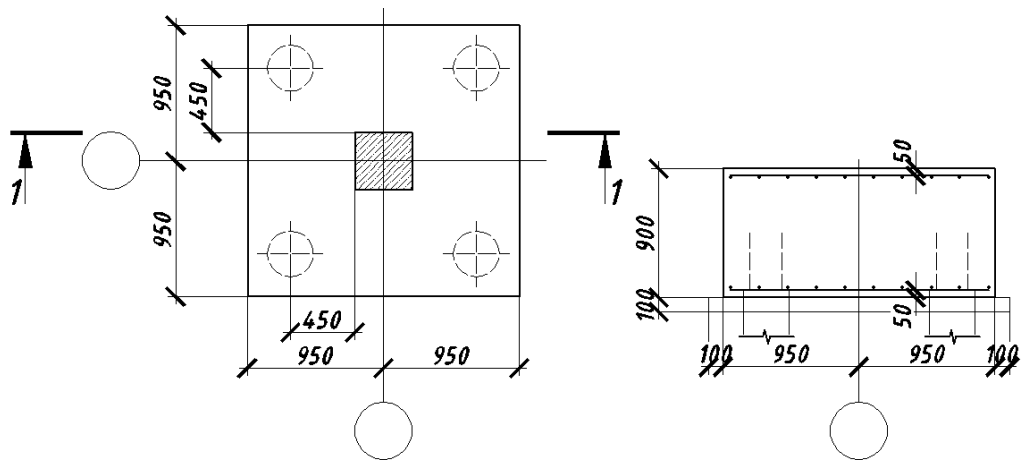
Расчетная схема при определении арматуры подошвы фундамента
